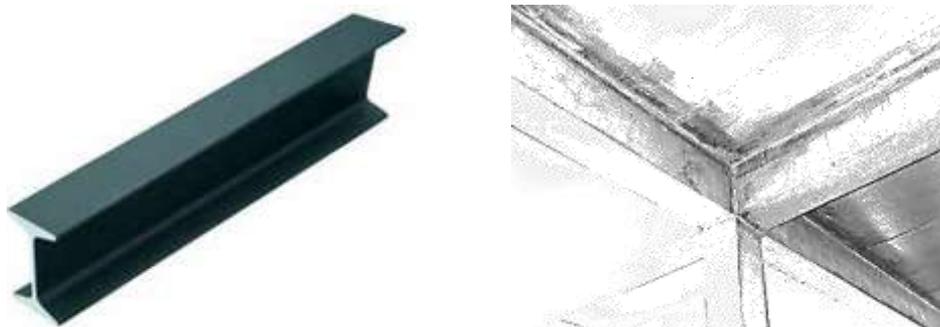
Tipos de vigas (perfil metálico e betão armado). Fonte: revistatechne.com
